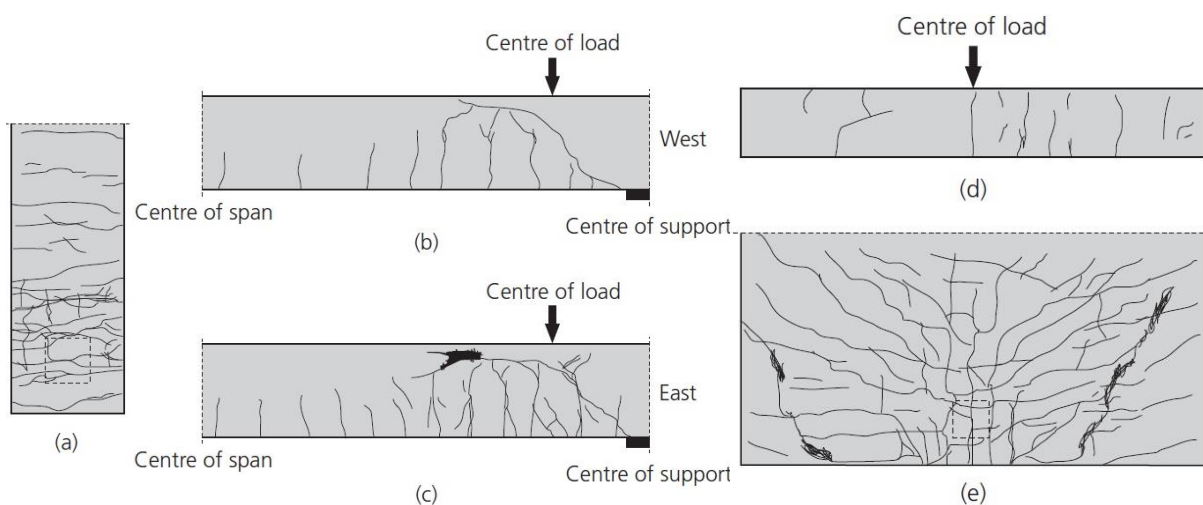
Cisaillement unidirectionnel, fissuration après rupture: (a) face inférieure; (b) face latérale ouest; (c) face latérale est. Cisaillement bidirectionnel, fissuration après rupture: (d) face avant; (e) face inférieure Lantsoght et al. 2014 [18], Lantsoght et al. 2013 [19]
